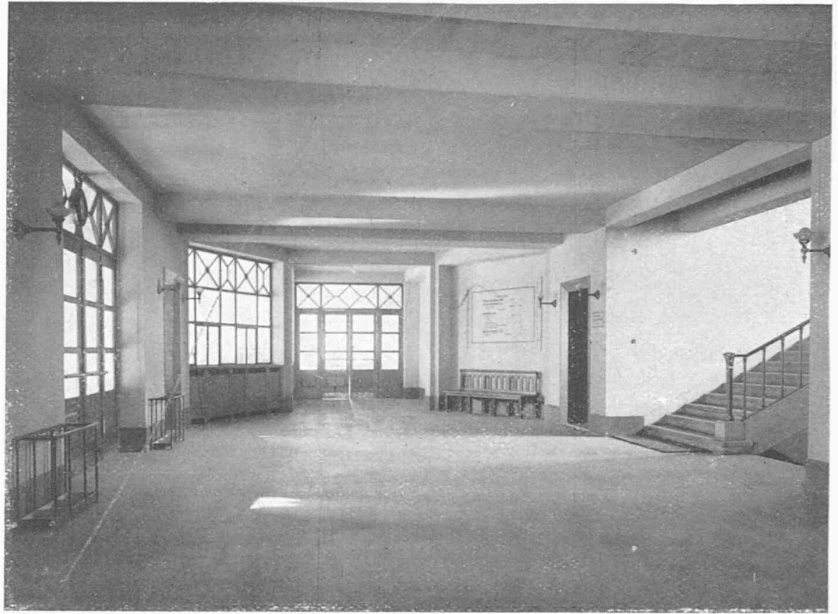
Schalterhalle im Erdgeschoss des Hauptgebäudes.
